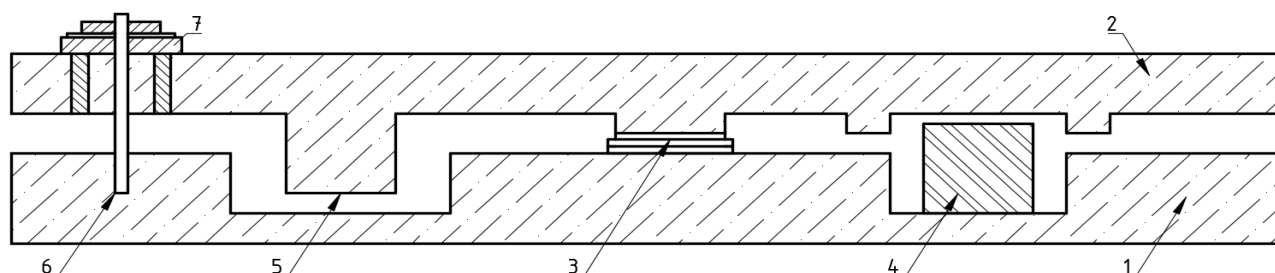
Скользящая опора (скользящий пояс): 1 – верхняя обвязка фундаментов; 2 – ростверк; 3 – скользящая опора; 4 – ограничитель горизонтальных перемещений; 5 – жесткий ограничитель горизонтальных перемещений; 6 – ограничитель вертикальных перемещений; 7 – вертикальный амортизатор
